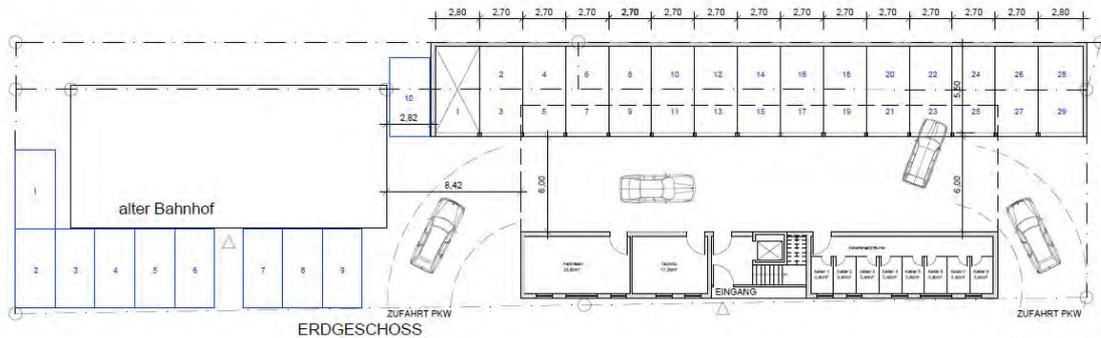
Grundriss Erdgeschoss (westlicher Teil der Wohnanlage) nach [1.a]
